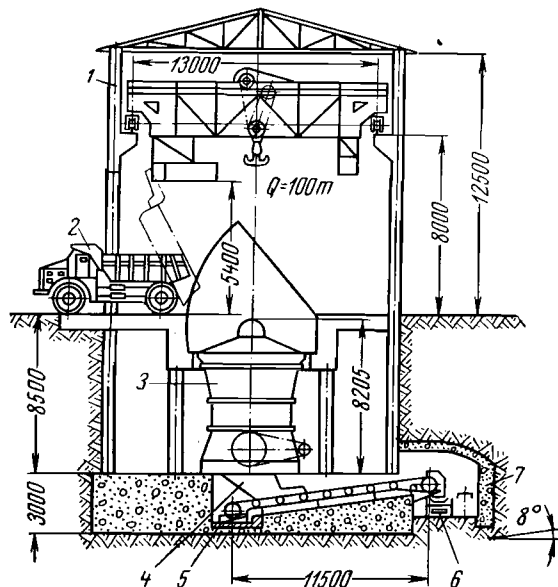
Схема дробильно-перегрузочного узла в карьере: 1 — здание дробильно-перегрузочного узла; 2 — автосамосвал; 3 — дробилка; 4 — направляющий желоб; 5 — пластинчатый питатель; 6 — ленточный конвейер; 7 — наклонный ствол
